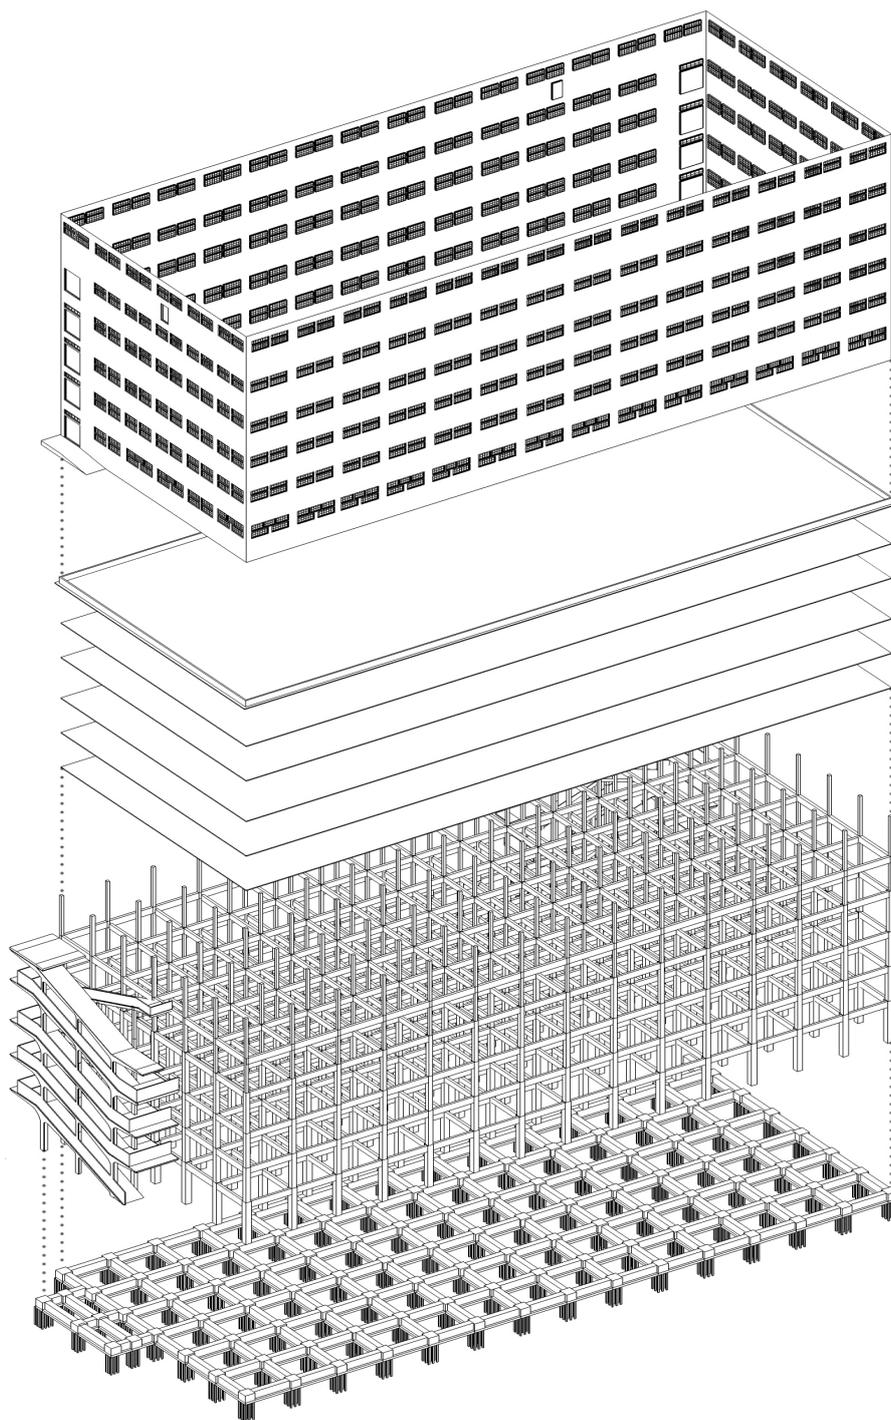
钢筋混凝土、砖墙、木屋架（楼板）混合结构体系示意图
